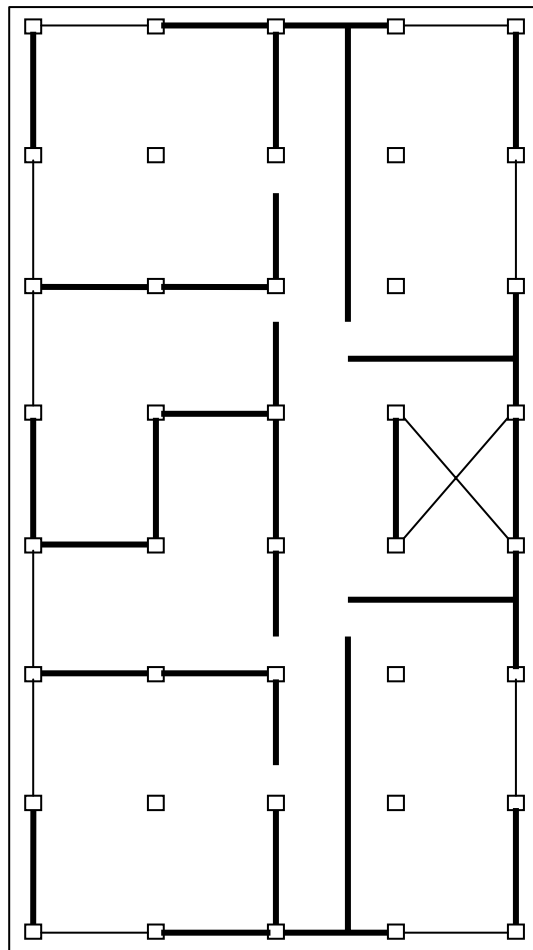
Planta arquitectónica del edificio de 14 niveles.
